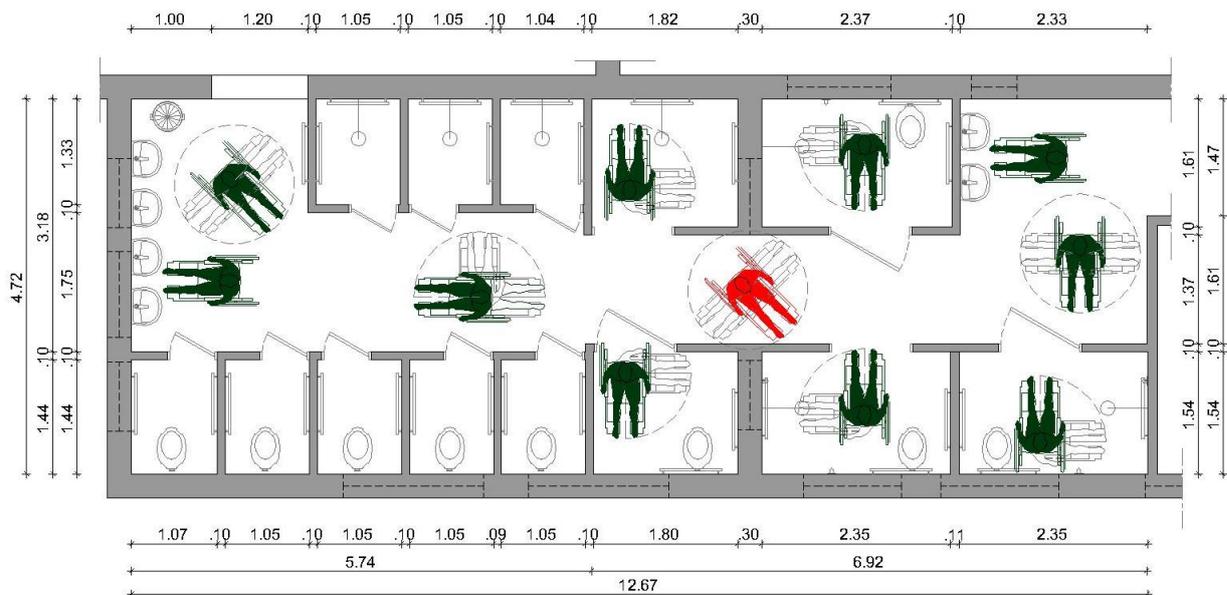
ILPI 2 - Planta baixa banheiro coletivo feminino A.
